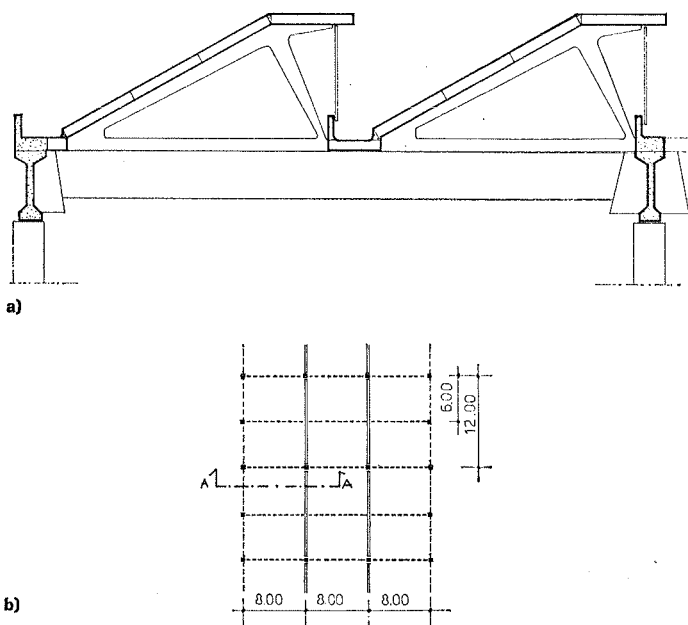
Copertura a shed. a) Sezione A-A; b) Schema della pianta.
